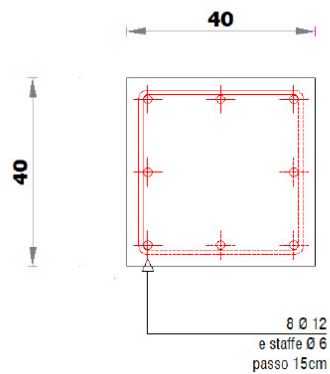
rilievo delle armature di un elemento strutturale tipo (Fonte: studio di vulnerabilità sismica).
